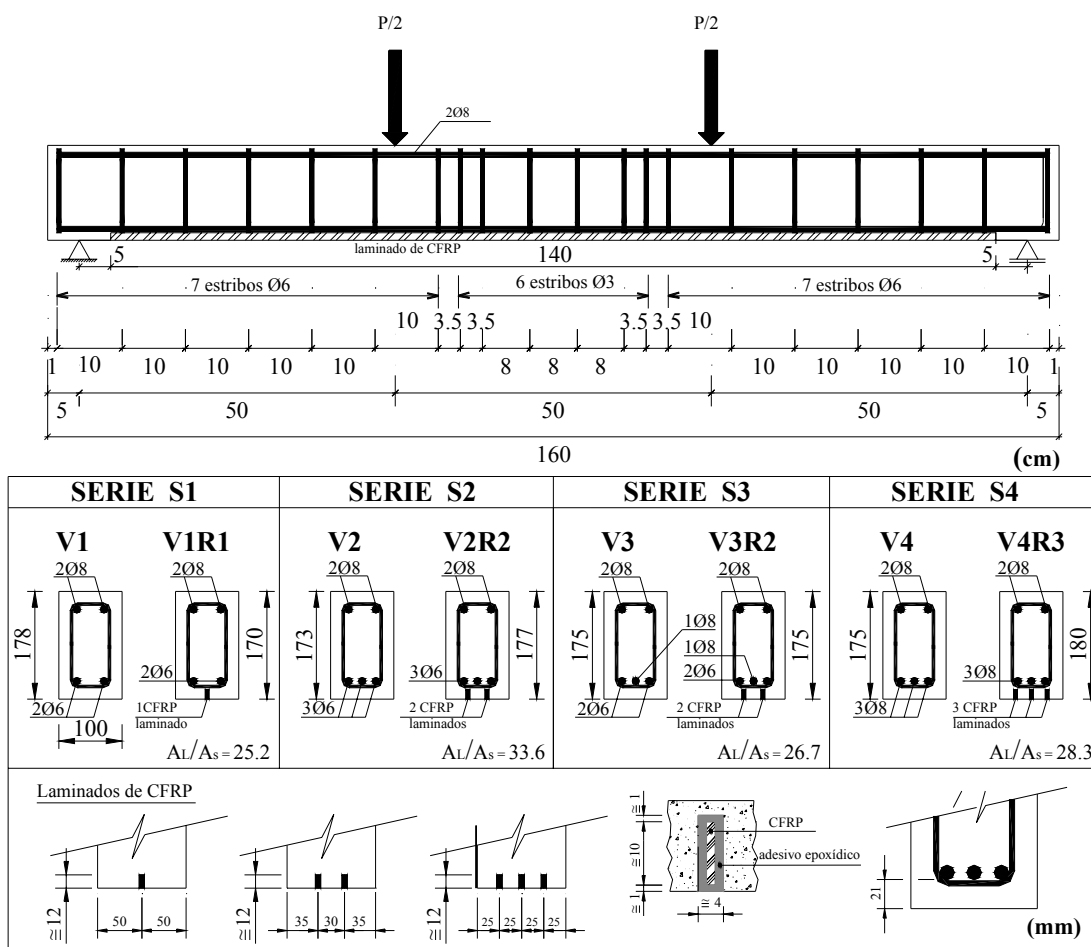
Geometria, armaduras e reforço das vigas (Fortes et al., 2002).
